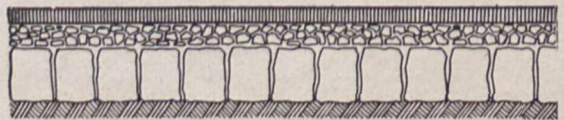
Gußasphalt auf vorhandener Chaussierung.
